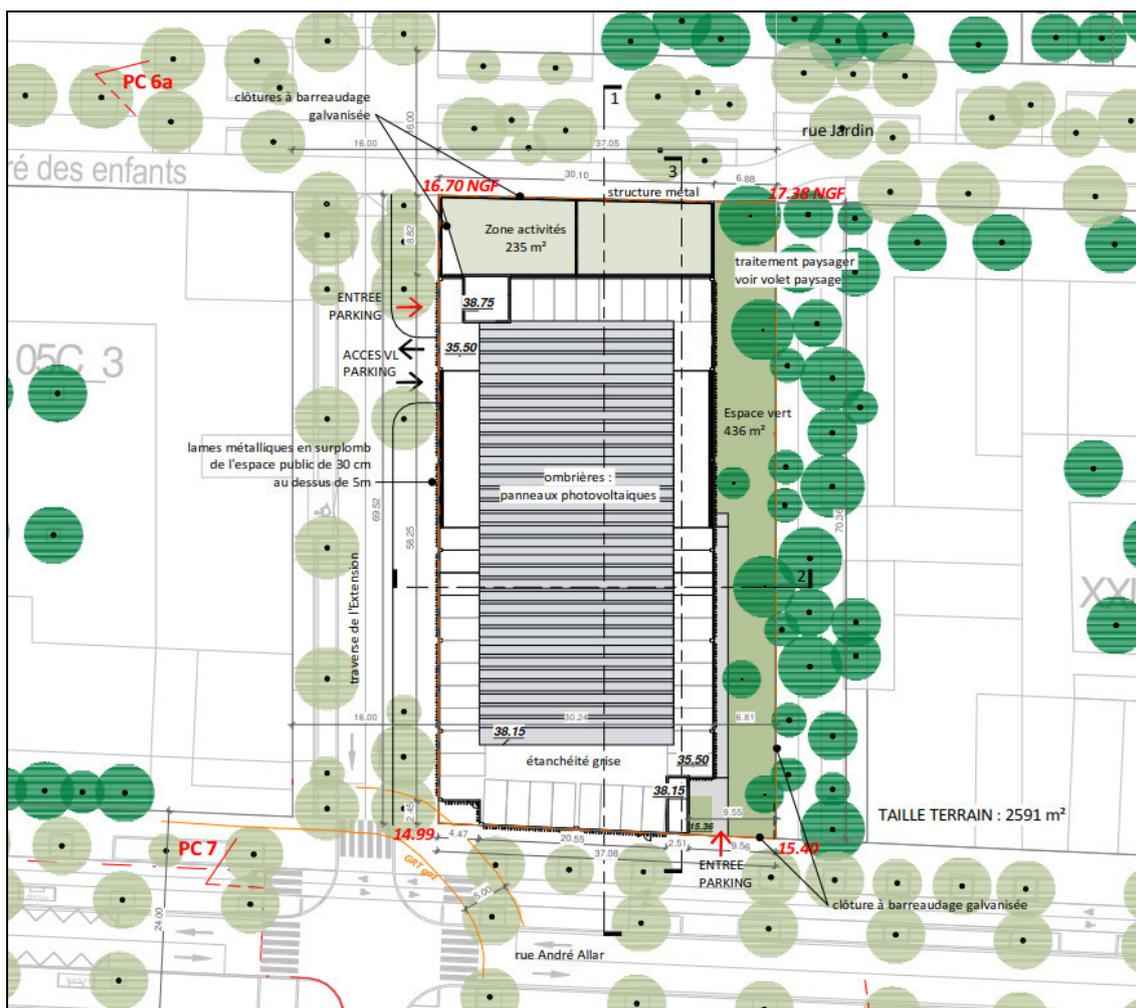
Plan masse de l'îlot 4C1 (source : Linkcity, 2019)
